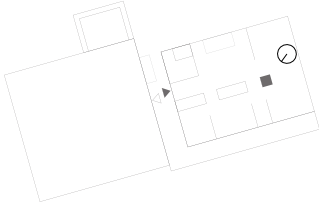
Grundriss Untergeschoss
